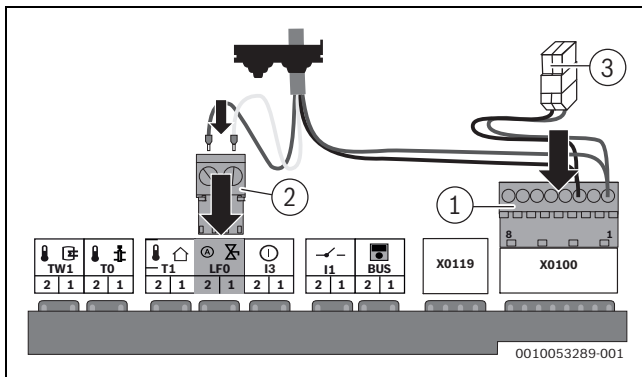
Collegare la valvola di riempimento automatica di apparecchi di sistema / solo caldaie murali
